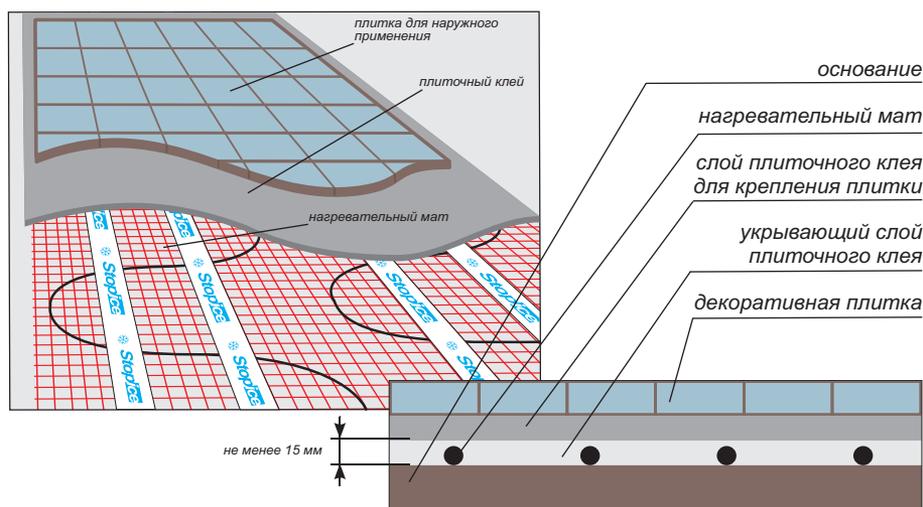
Разрез конструкции обогревательной поверхности с использованием нагревательных матов
